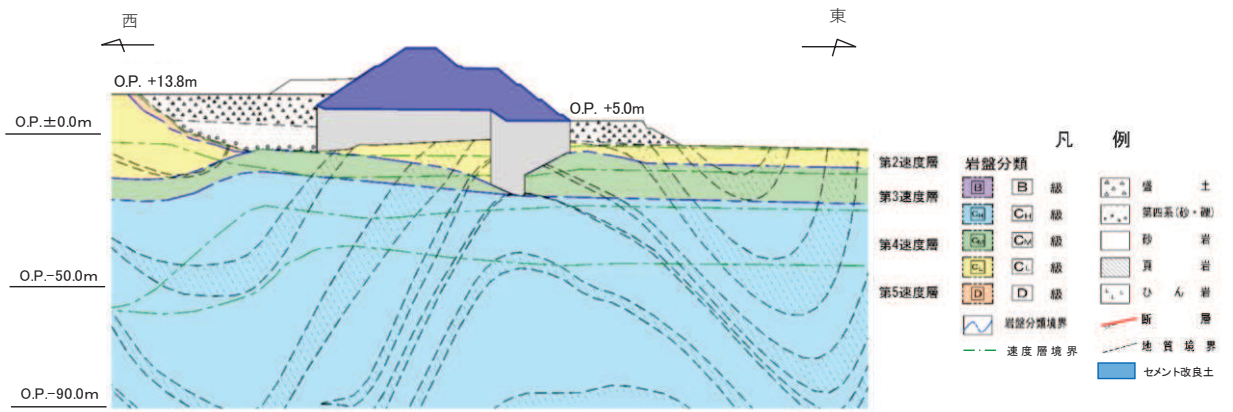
セメント改良土の配置図（防潮堤（盛土堤防），断面①）
